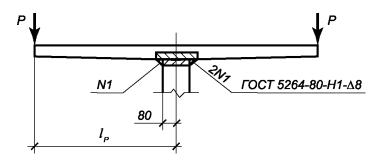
Схема испытания ступеней типоразмеров ЛСС 12 и ЛСС 15
